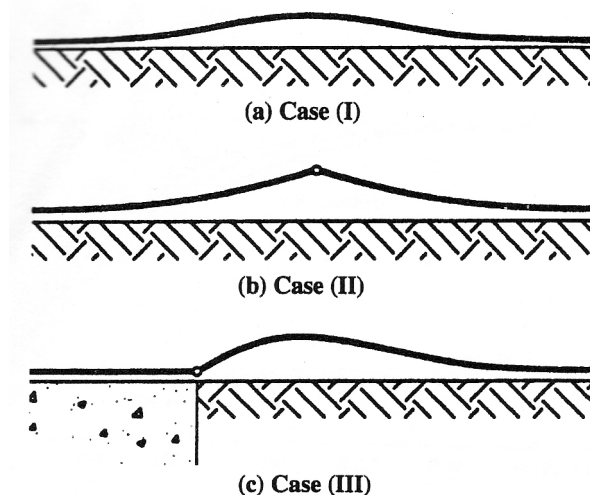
Aufwölbungsarten von Betonfahrbahnen: Case (I) – durchgehend bewehrte Betonfahrbahn; Case (II) – Betonfahrbahn mit Fuge (Gelenk); Case (III) – an ein festes Widerlager angrenzende Betonfahrbahn [26]
